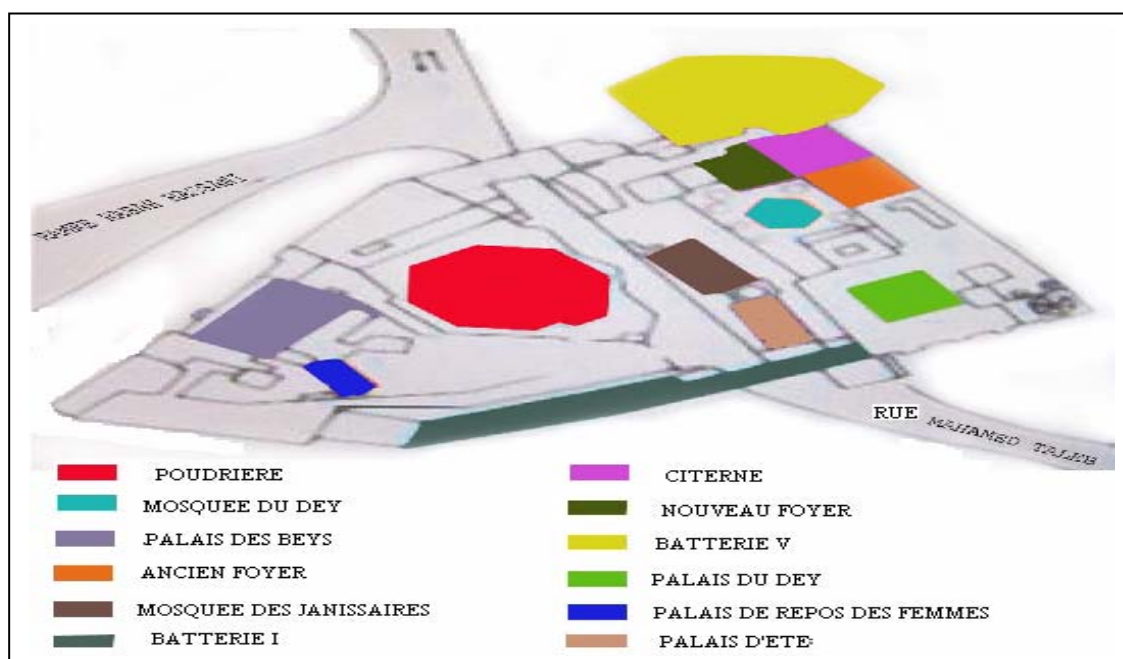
Plan de masse de la Citadelle d'Alger.
